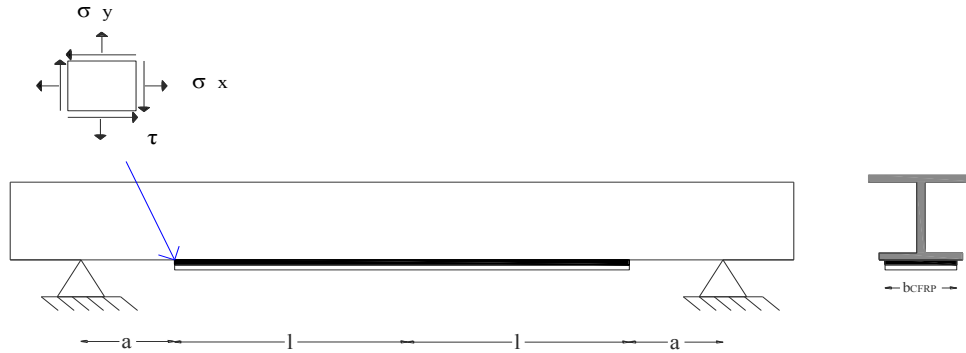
Esfuerzos axiales y cortante en la interfase acero y CFRP, en una viga de acero simplemente apoyada.
